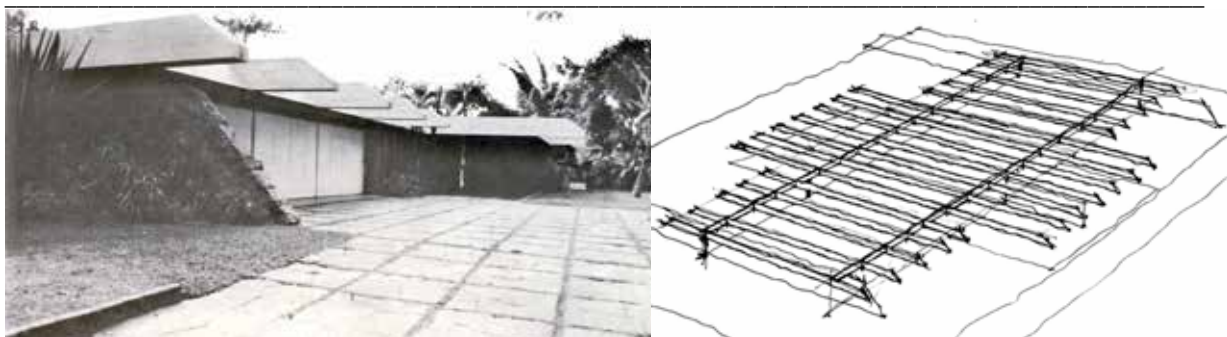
Casa Guido Weber; Forte & Gandolfi; vista fachada sul: acesso de veículos e hall de entrada.
